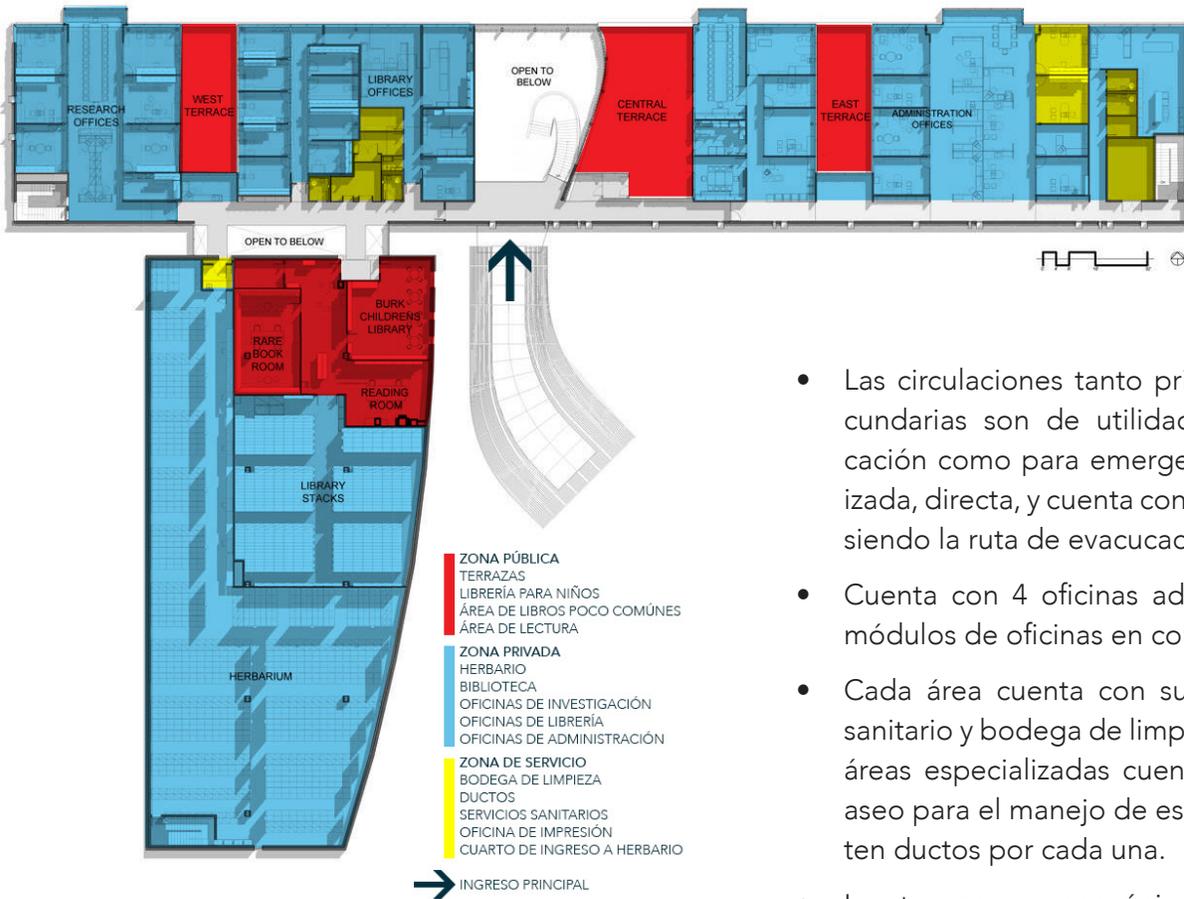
Esquema de zonificación de Planta Alta, elaboración propia sobre plano de H3 Hardy Collaboration Architecture, (Archdaily, 2012).
